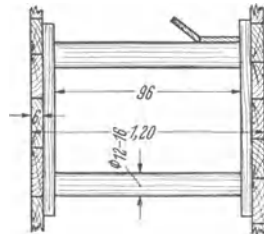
Sickerschacht, Querschnitt der Baugrube.
